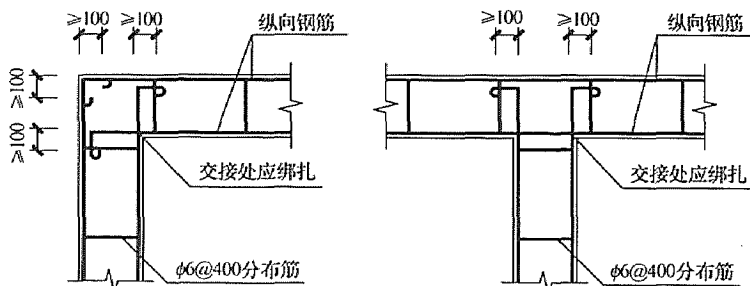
配筋砂浆带交接处钢筋搭接做法
